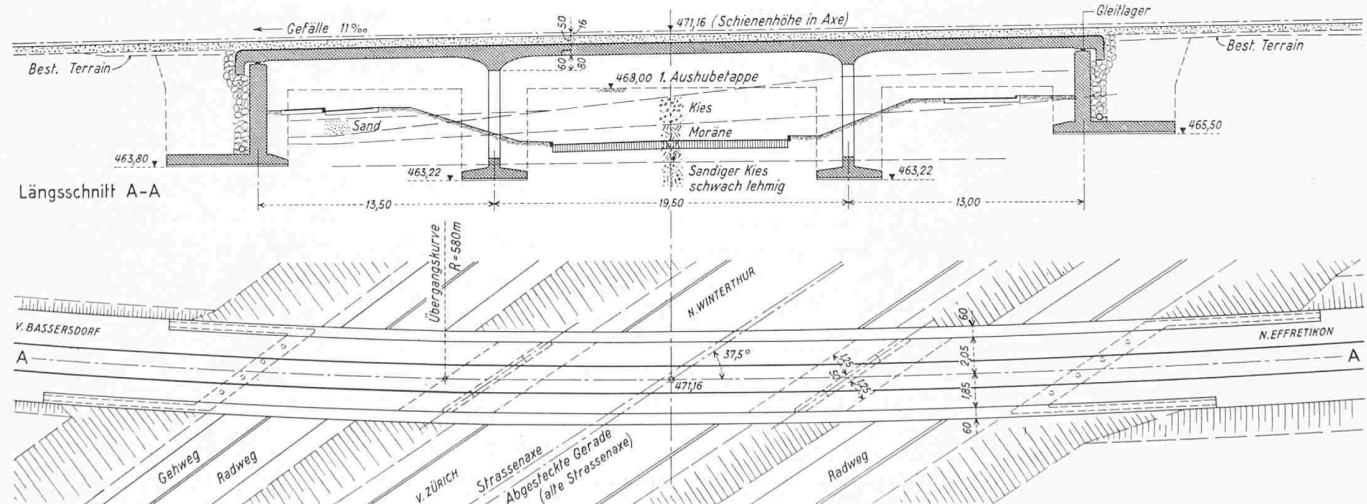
Längsschnitt durch die Mittelaxe und Grundriss, Masstab 1:400
